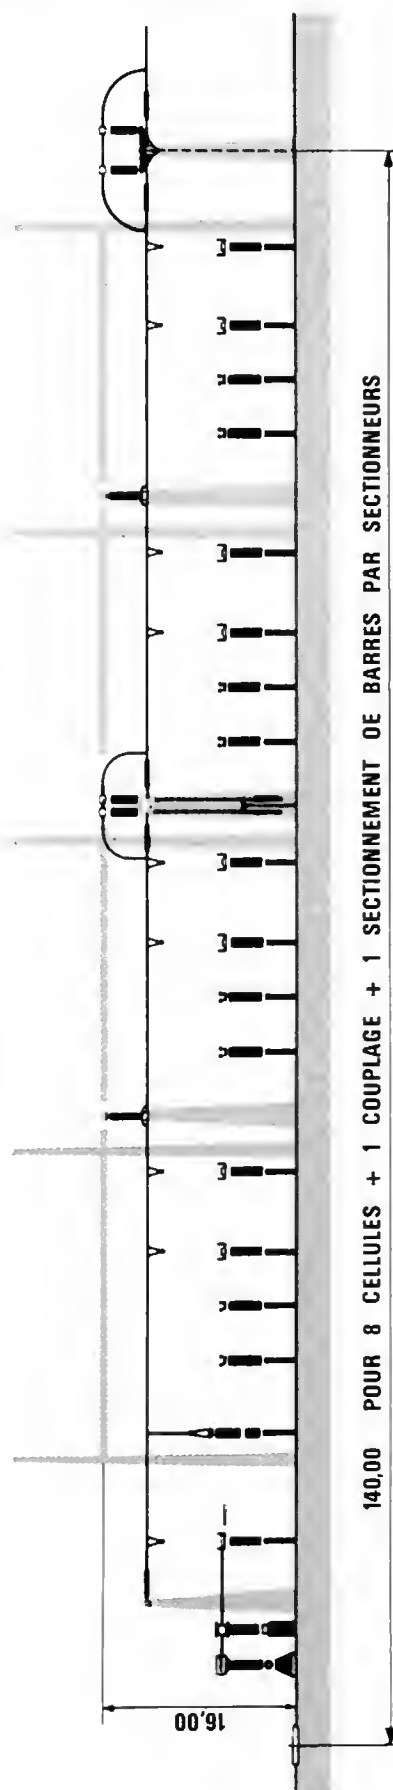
Jeu de barres (coupe longitudinale).
